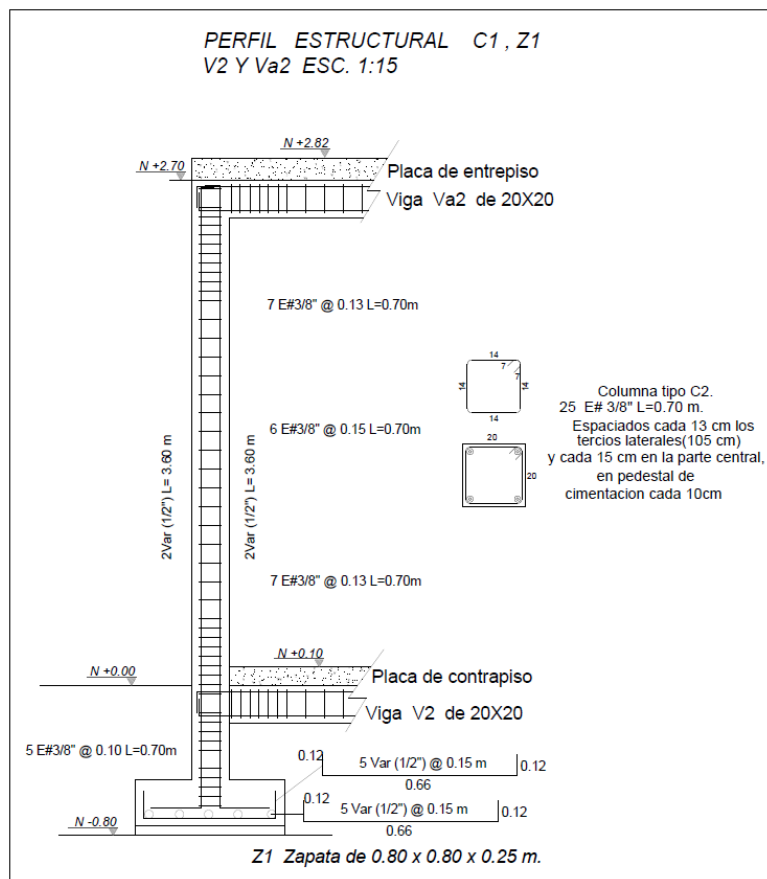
Detalle despiece de zapata Z1 y columna C1 de batería sanitaria Casa Cabildo
